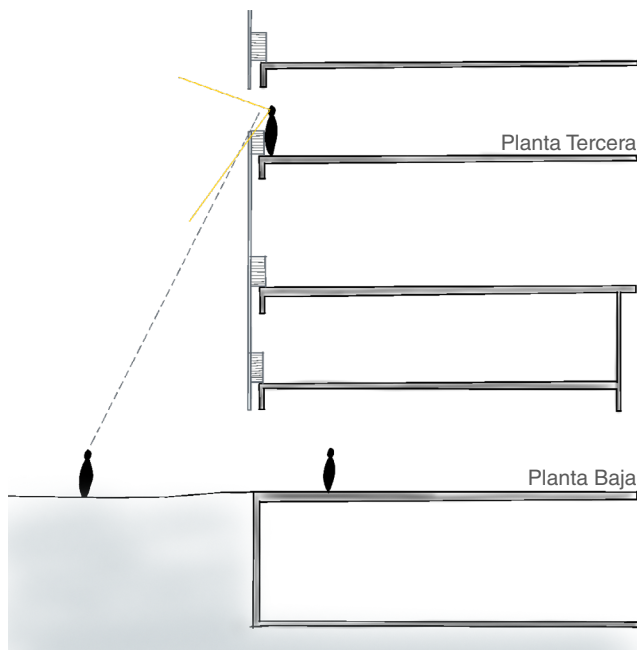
Esquema relación de la calle con los usuarios de la planta baja y de la planta tercera. (Autoría propia, 2022).
